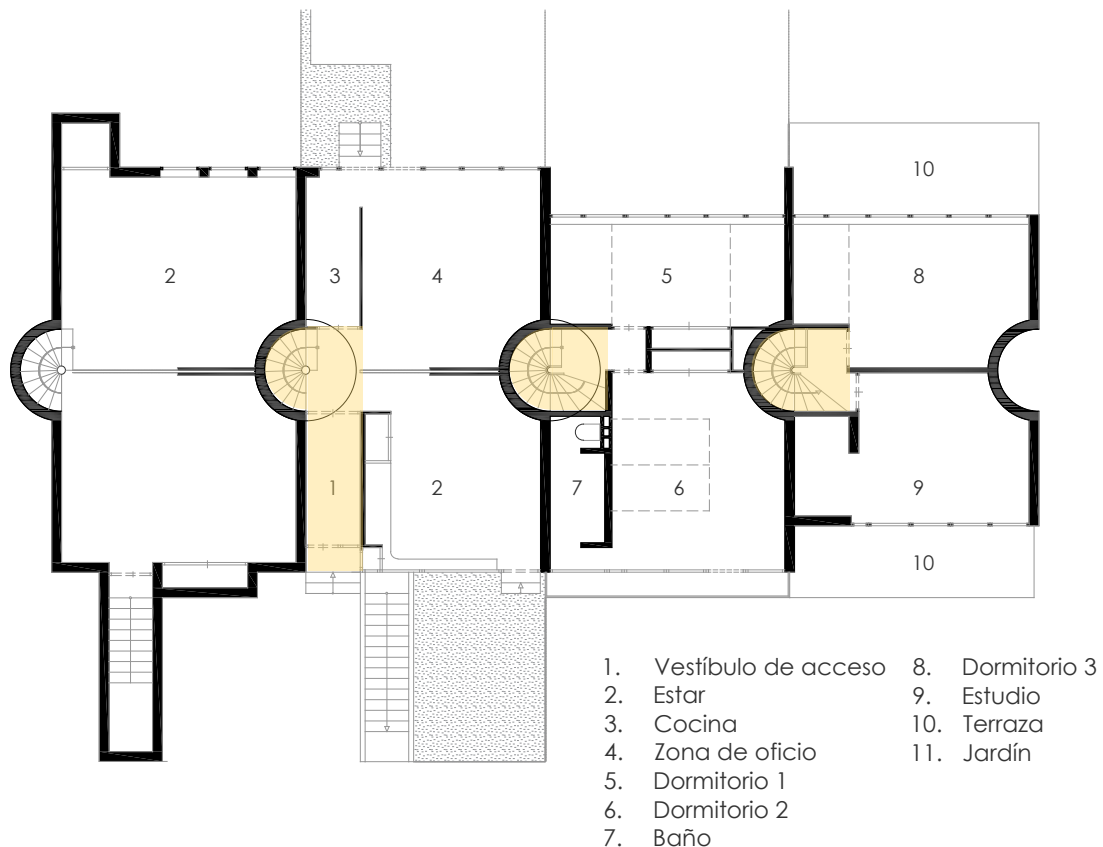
Planta sótano, baja, primera y segunda con elemento Kernhuis.
